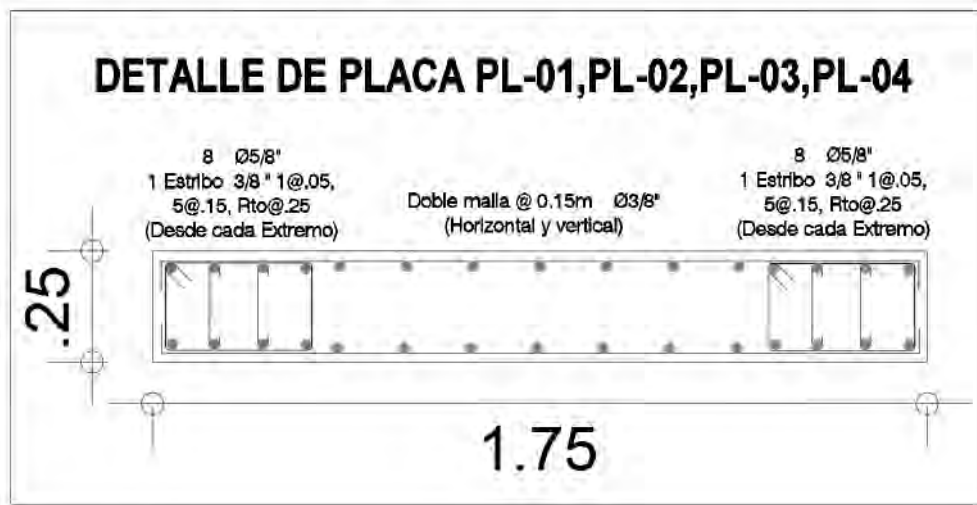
Detalle final de las placas añadidas, primera propuesta de reforzamiento
